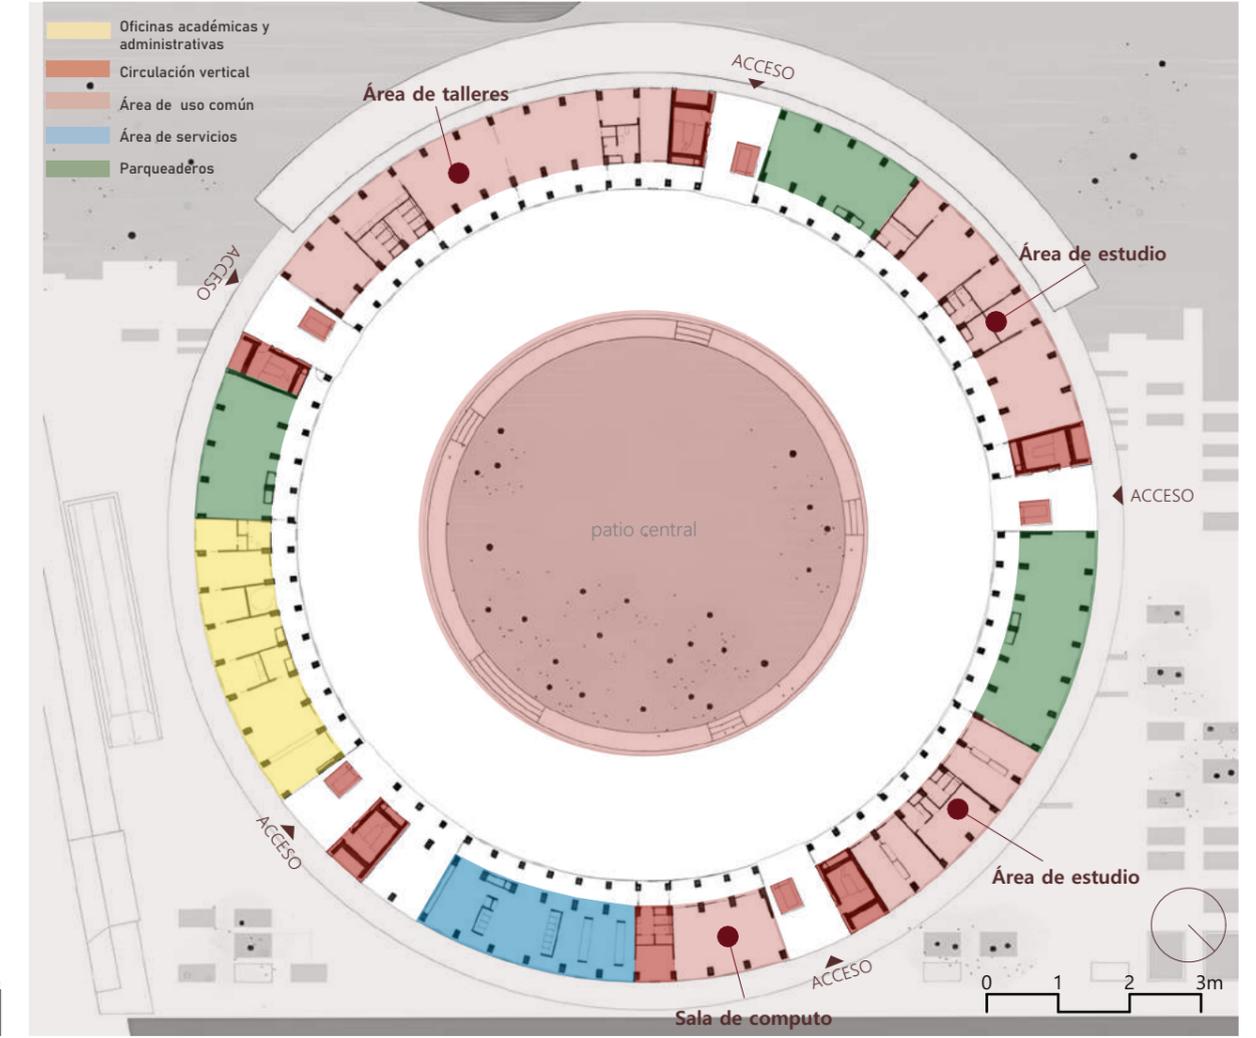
Planta esquemática edificio Tietgen Dormitory Fuente. Autoría Propia
